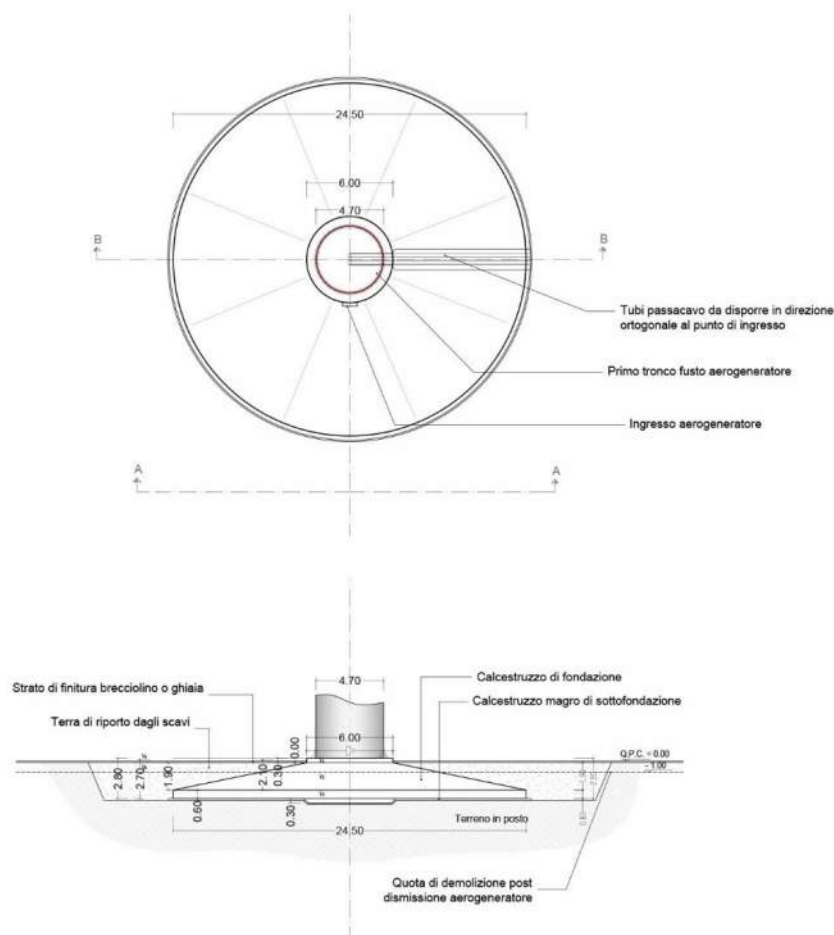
Pianta e vista della fondazione tipo dell'aerogeneratore
